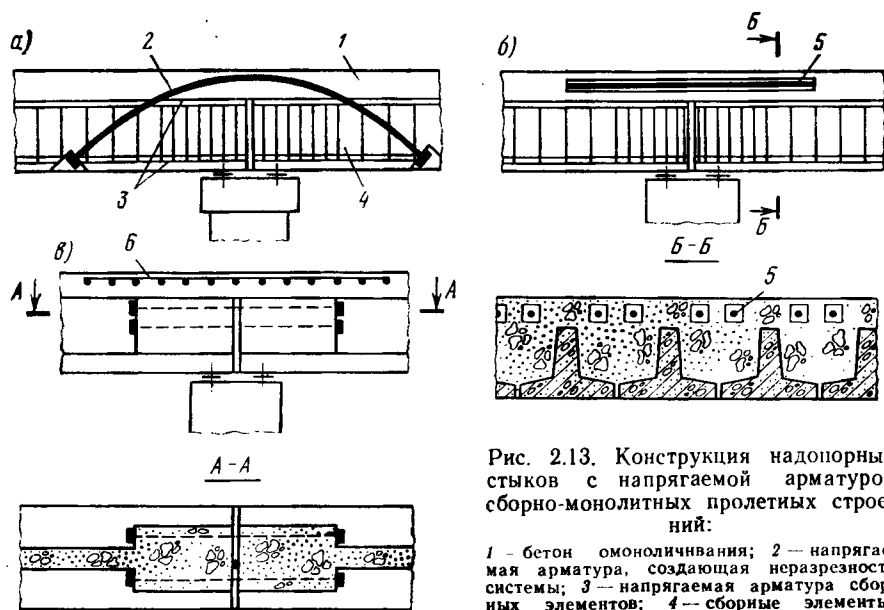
Конструкция надпорных стыков с напрягаемой арматурой сборно-монолитных пролетных строений:
